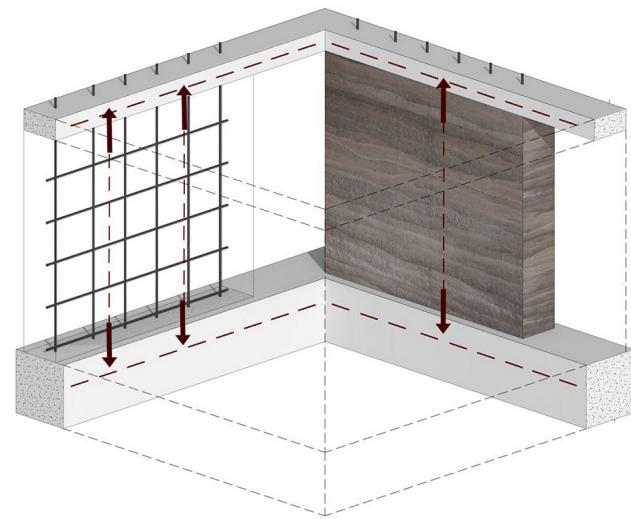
Diagrama de refuerzo en muros en tierra. Fuente: Plataforma arquitectura.
